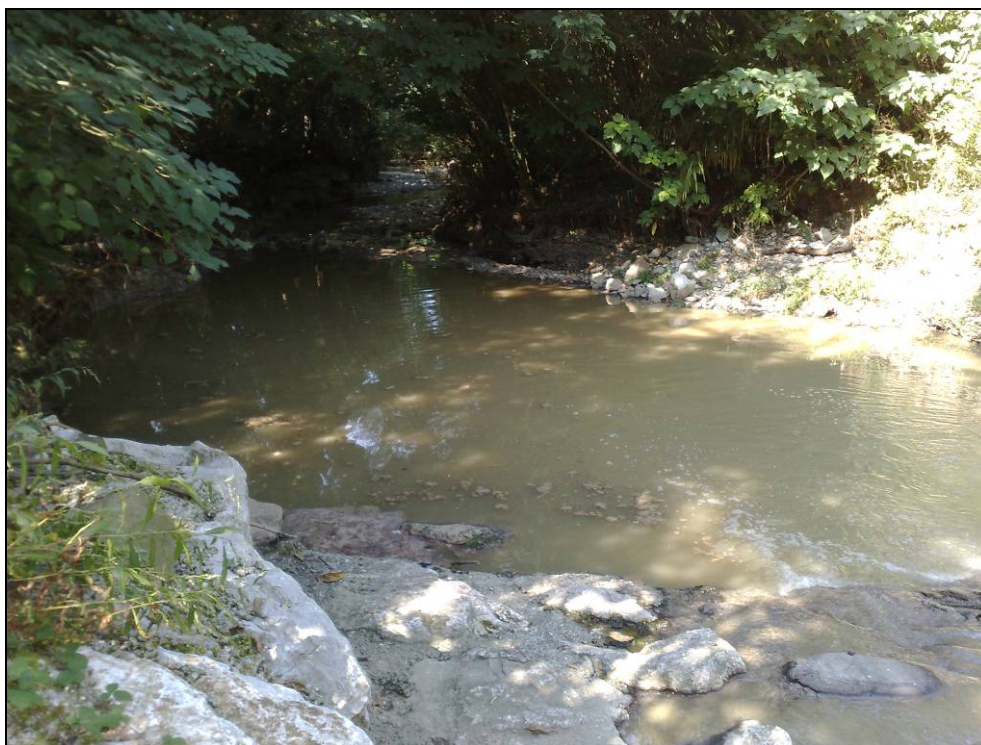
precaria sistemazione spondale con massi a valle del terrapieno di Viale Oriani.
